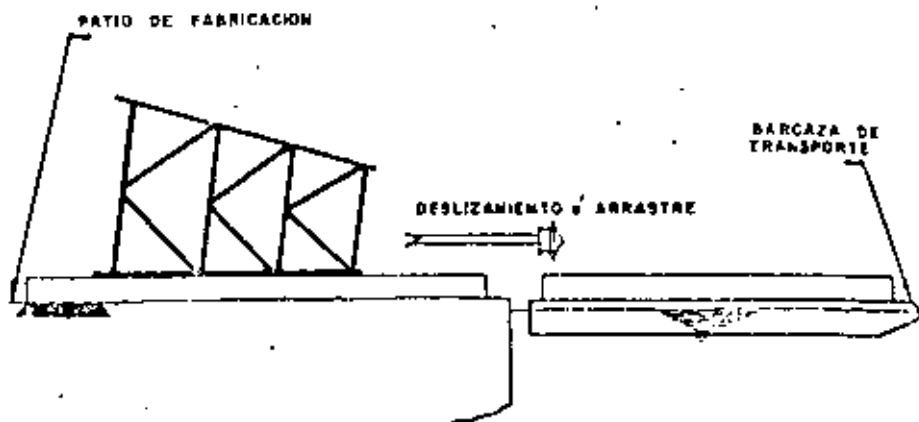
CARGA DE LA SUBESTRUCTURA
